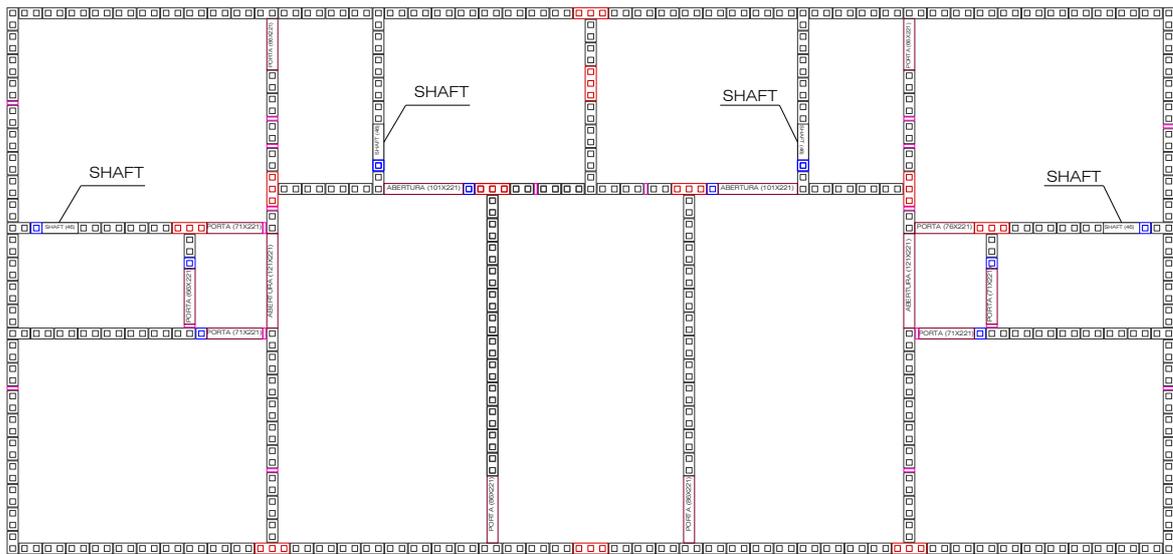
Posição dos *shafts* na planta de forma da primeira fiada.
